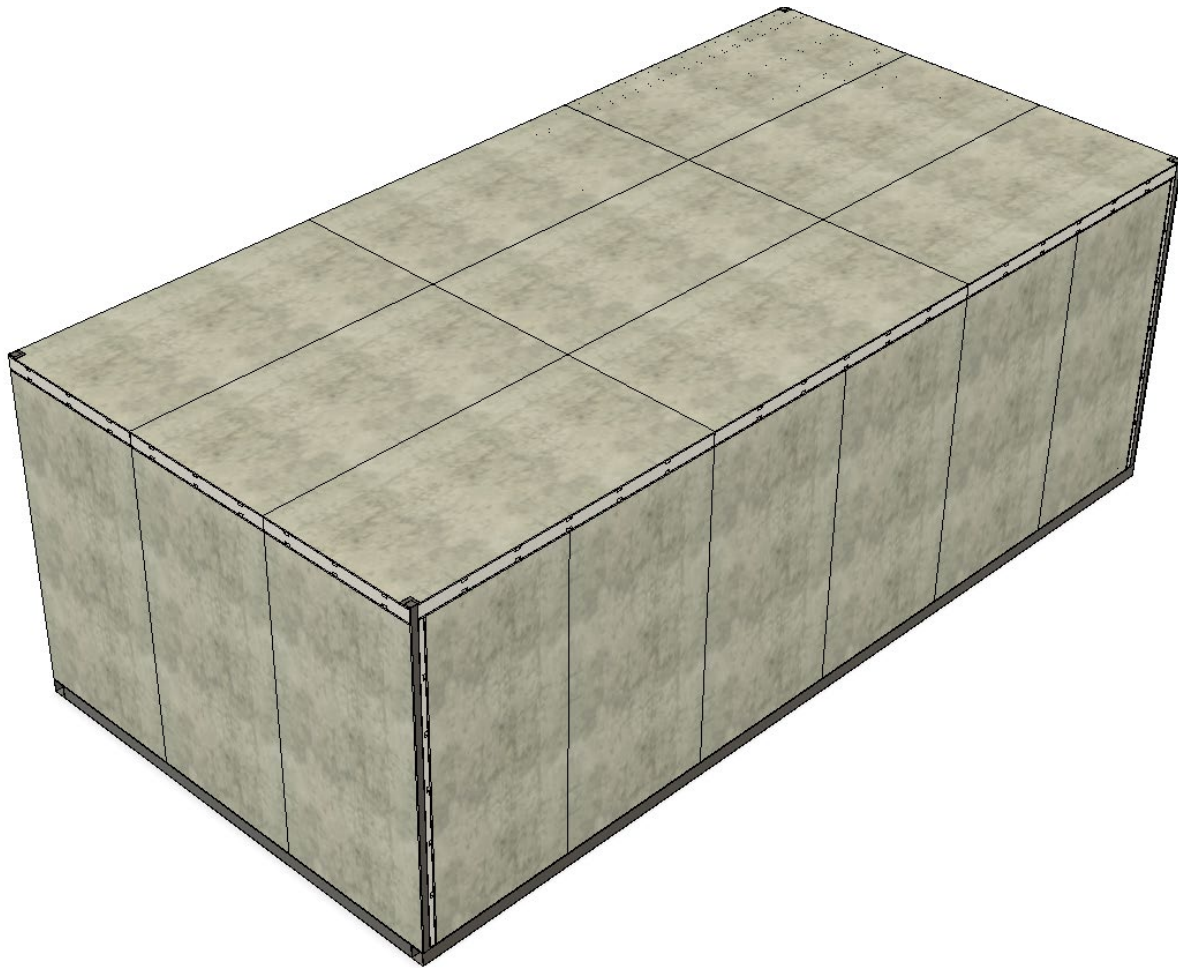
Diseño de la envolvente, paneles, conectores y refuerzos estructurales. Elaboración propia.
